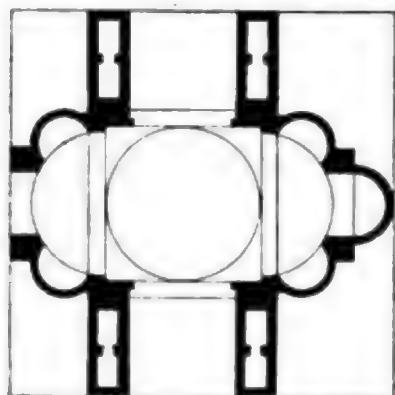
Esquema estático de la planta de Santa Sofia. CONSTANTINOPLA.
